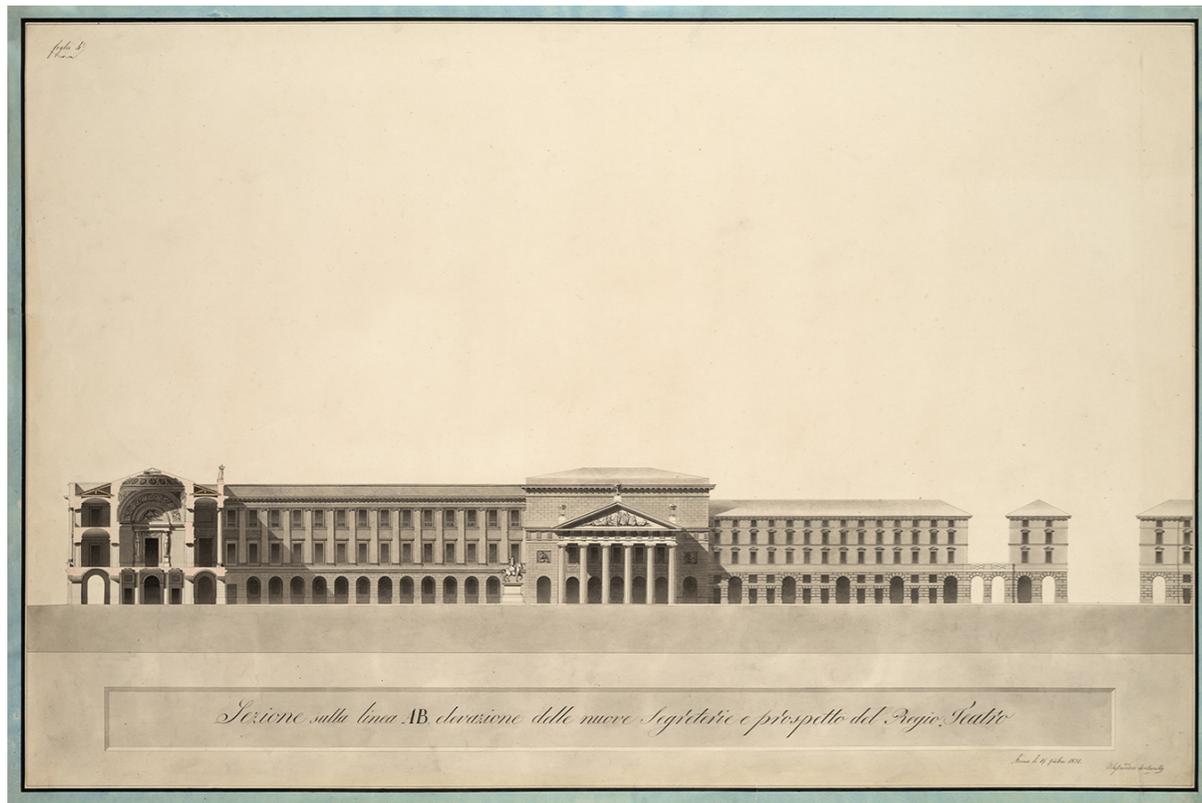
Sezione sulla linea A B, elevazione delle nuove Segreterie e prospetto del Teatro Regio di Alessandro Antonelli
